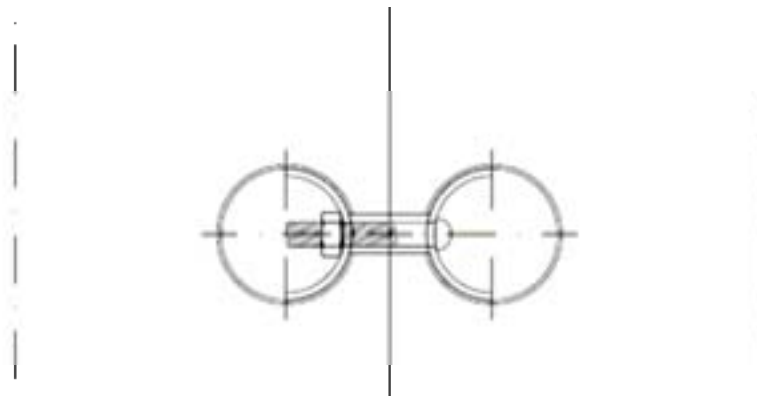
Skizze Plattenverbinder, 2 Bohraussparungen mit großem Durchmesser, Verbindungskanal für eine Schraube.
